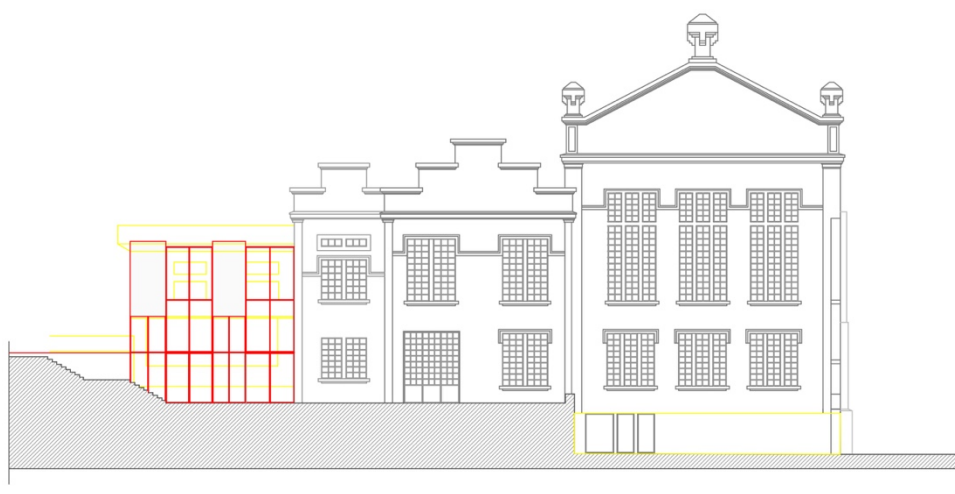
Sobreposição dos elementos a construir e a demolir, alçado poente;
